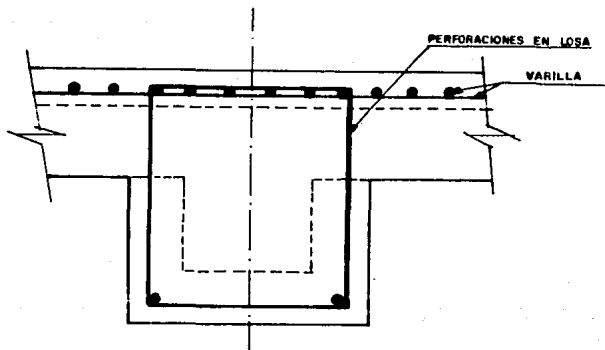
AUMENTO DE SECCION EN TRABES
